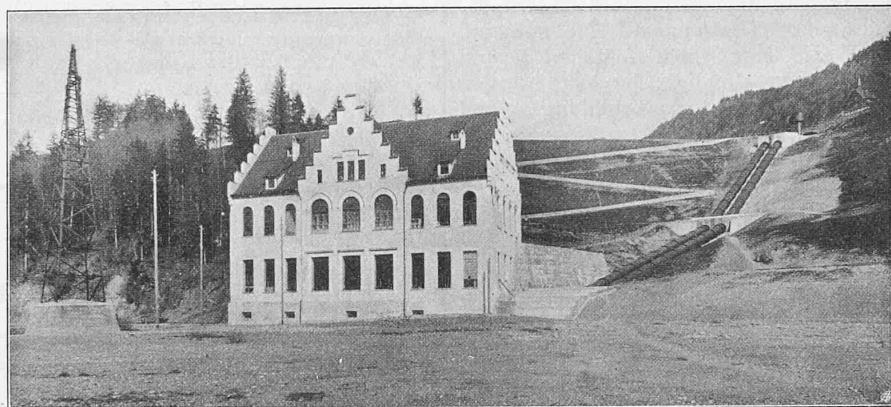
Ansicht des Maschinenhauses und der Druckleitung von Westen.
